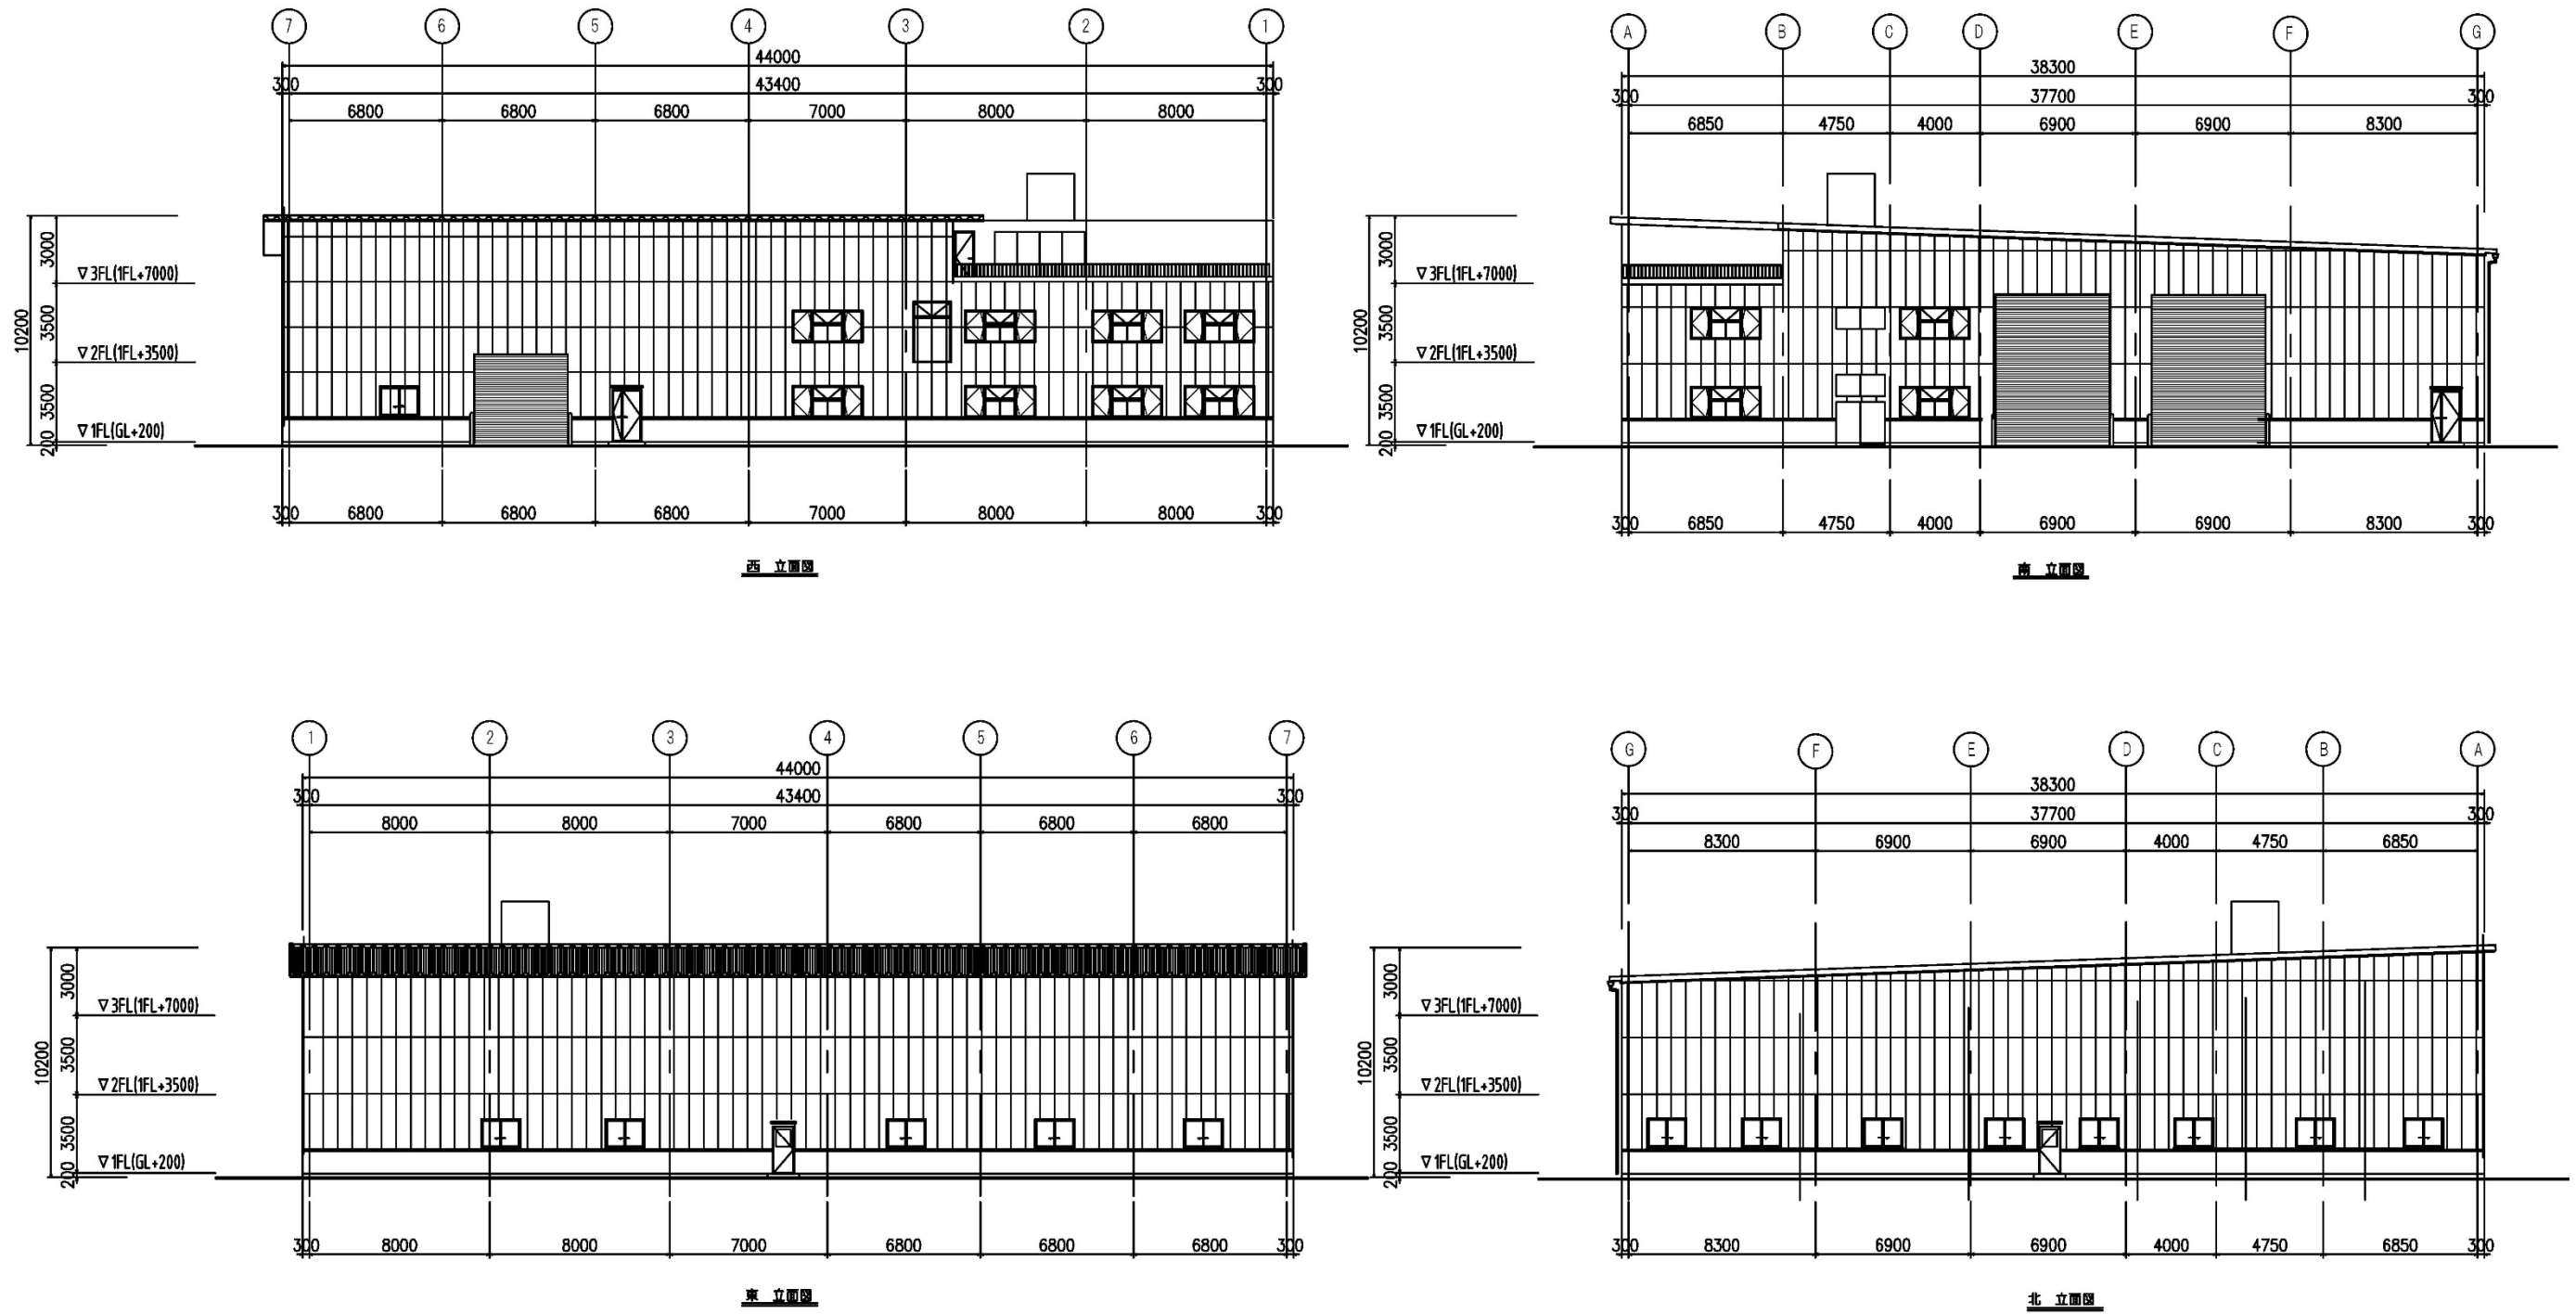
設備機器を設置する建屋の立面図 (想定)
